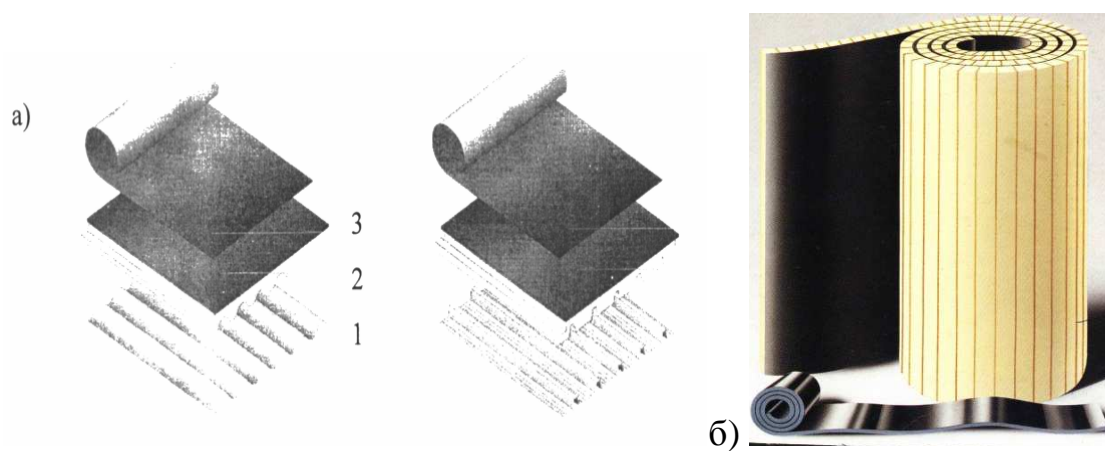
Утеплитель из пенополистирола со слоем гидроизоляции:
